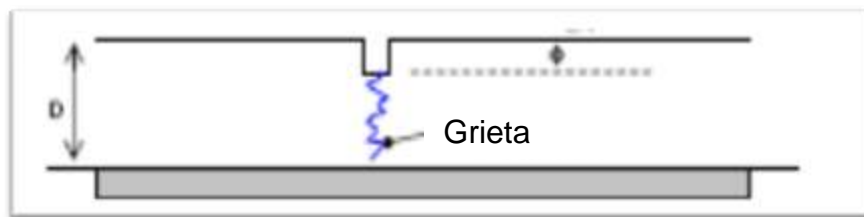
Esquema de grieta inducida, Fuente: Instituto Mexicano del Concreto.
